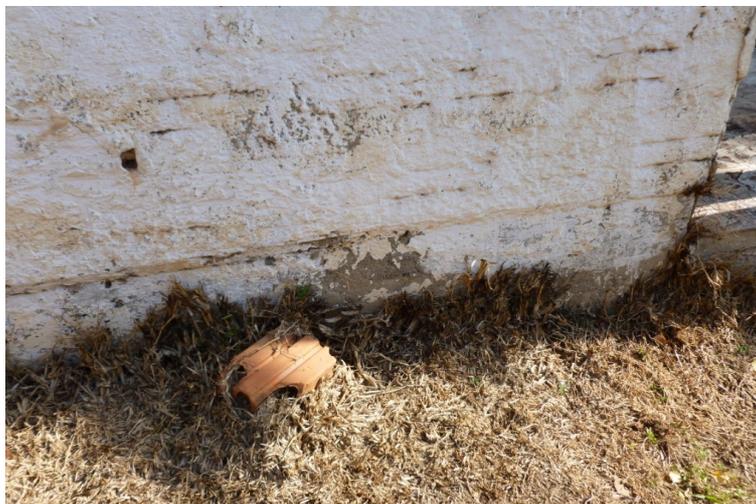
Viga de fundação separada da alvenaria em função da movimentação das fundações.
